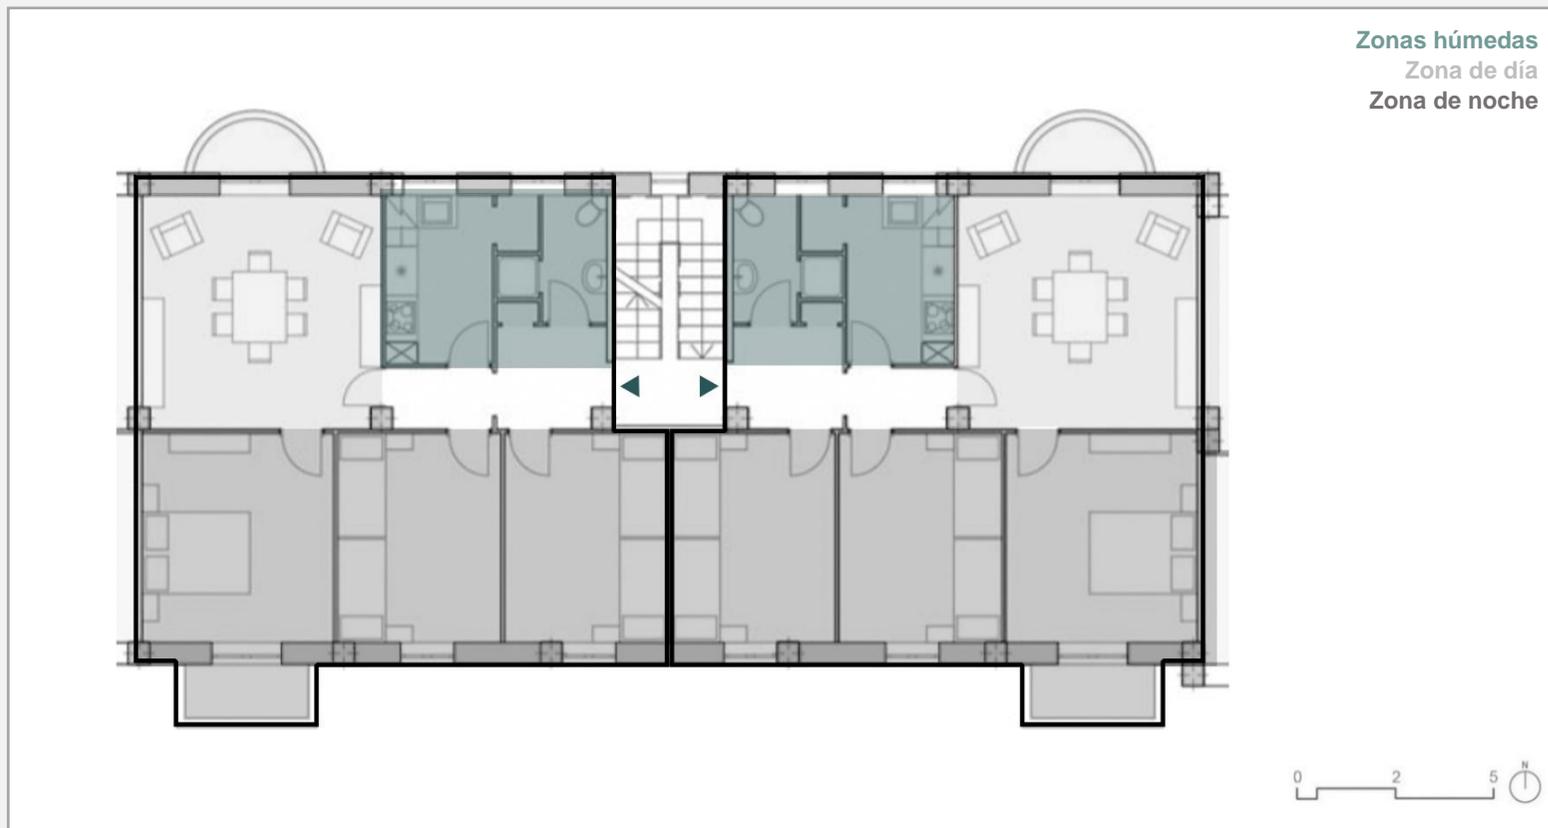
Grupo Residencial Federico Mayo. Planta tipo
